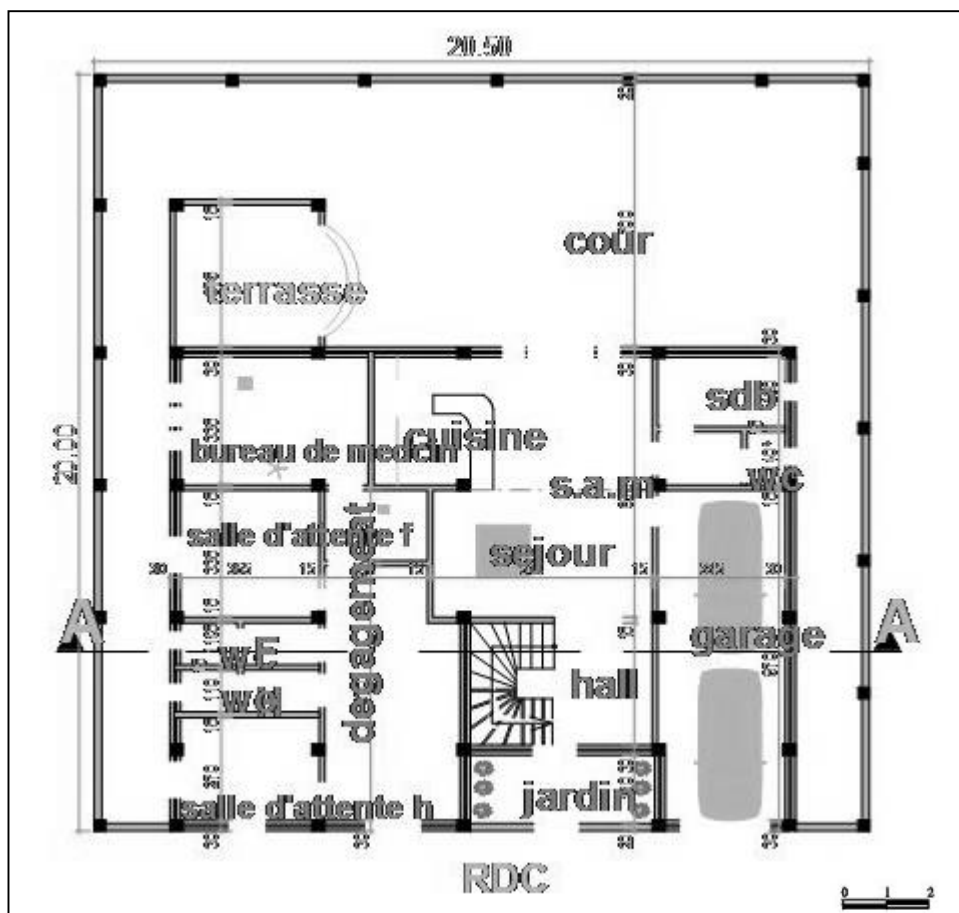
, échantillon 05, plan RDC d'une habitation individuelle prise comme plan type d'une maison a standing, lotissement OMAR BEN KHATTAB
